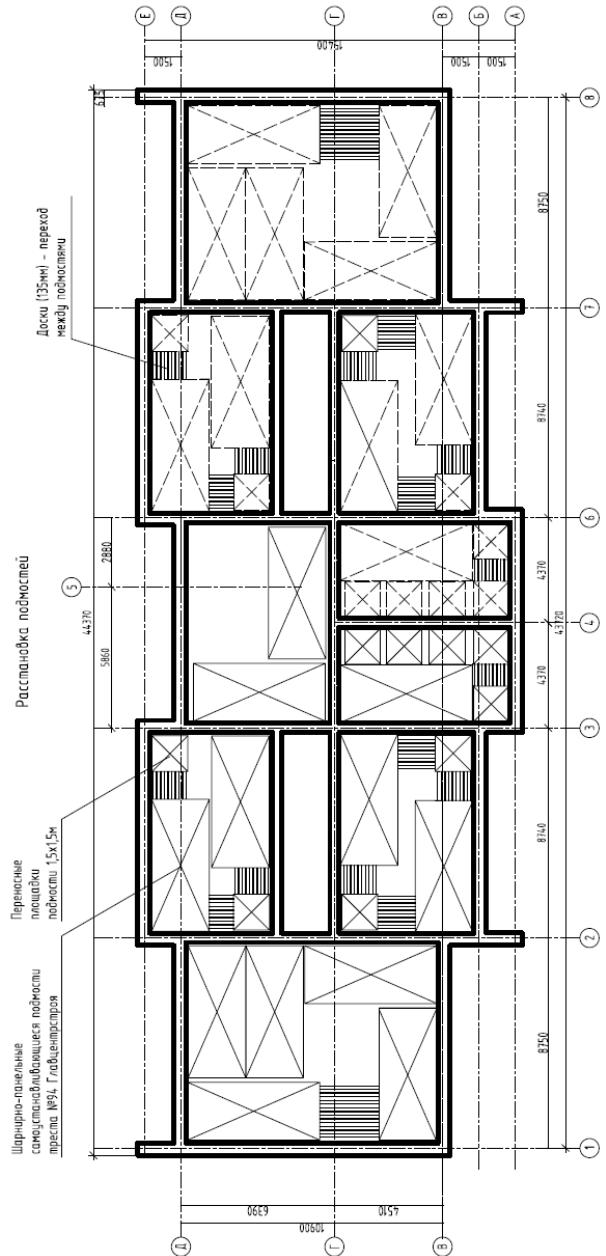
Схема расстановки подмостей при кладке наружных и внутренних стен
